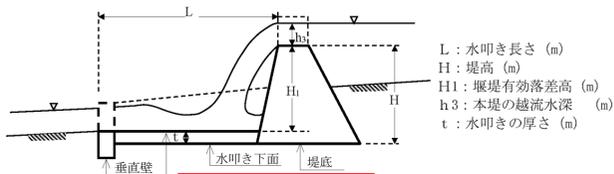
水叩き長さおよび水叩き厚さ（経験式の場合）
